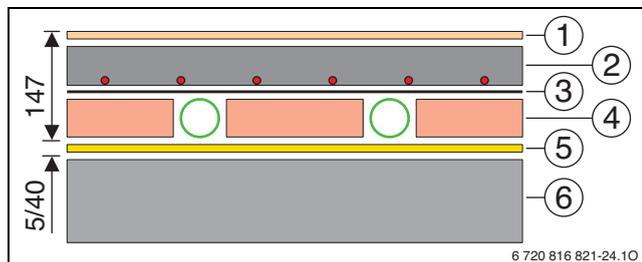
Canale tondo su soffitto in cemento grezzo (quote in mm)
